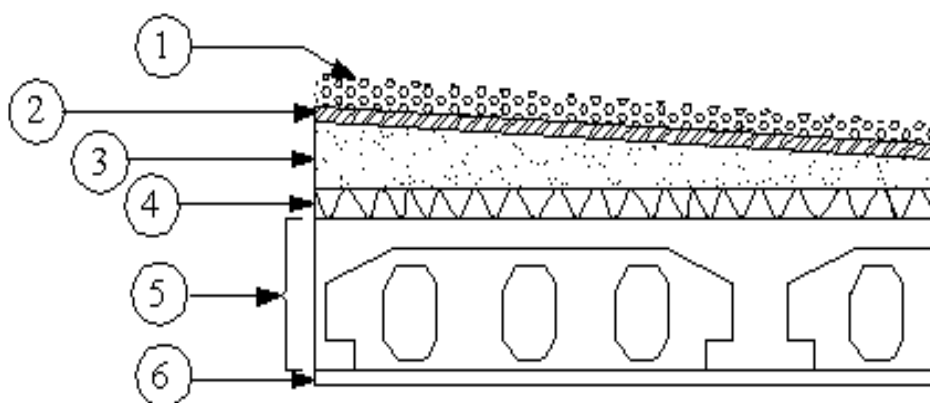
Coupe du plancher terrasse inaccessible (corps creux)
